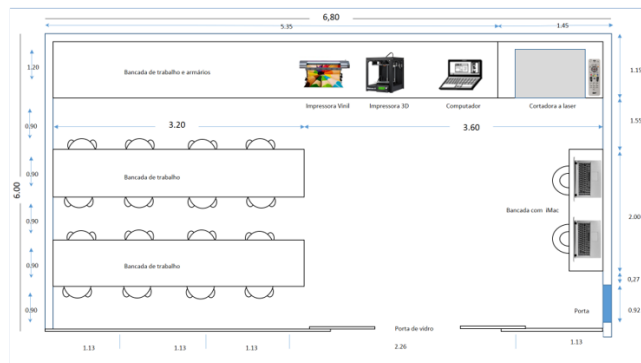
Desenho da planta baixa com medidas - Junho de 2016
